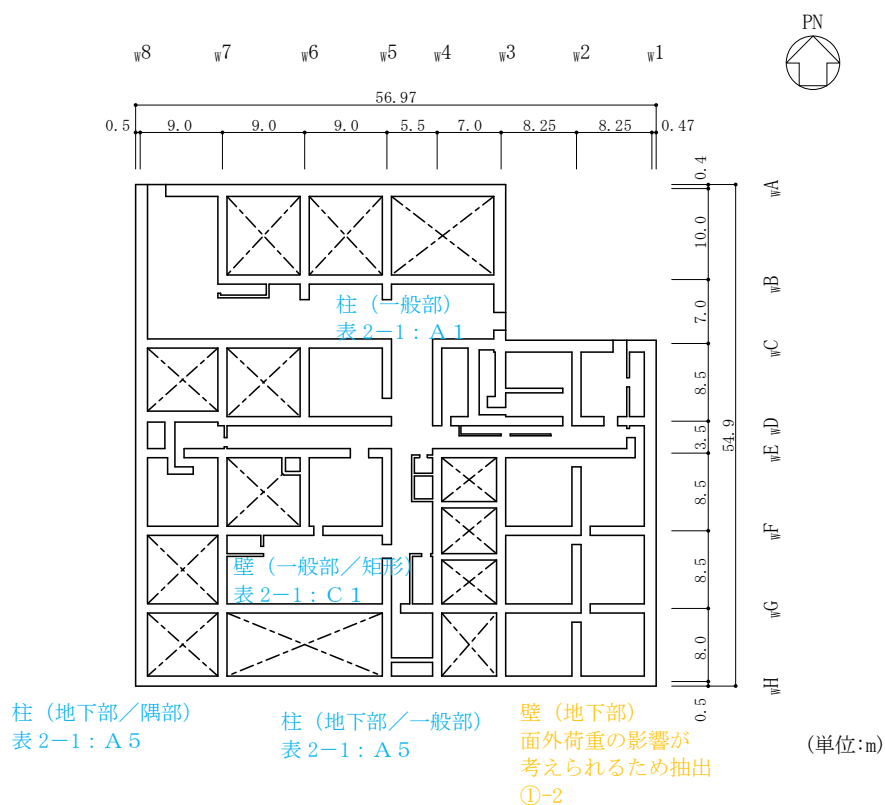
(2) 廃棄物処理建物の概略平面図 (EL 8.8m)
